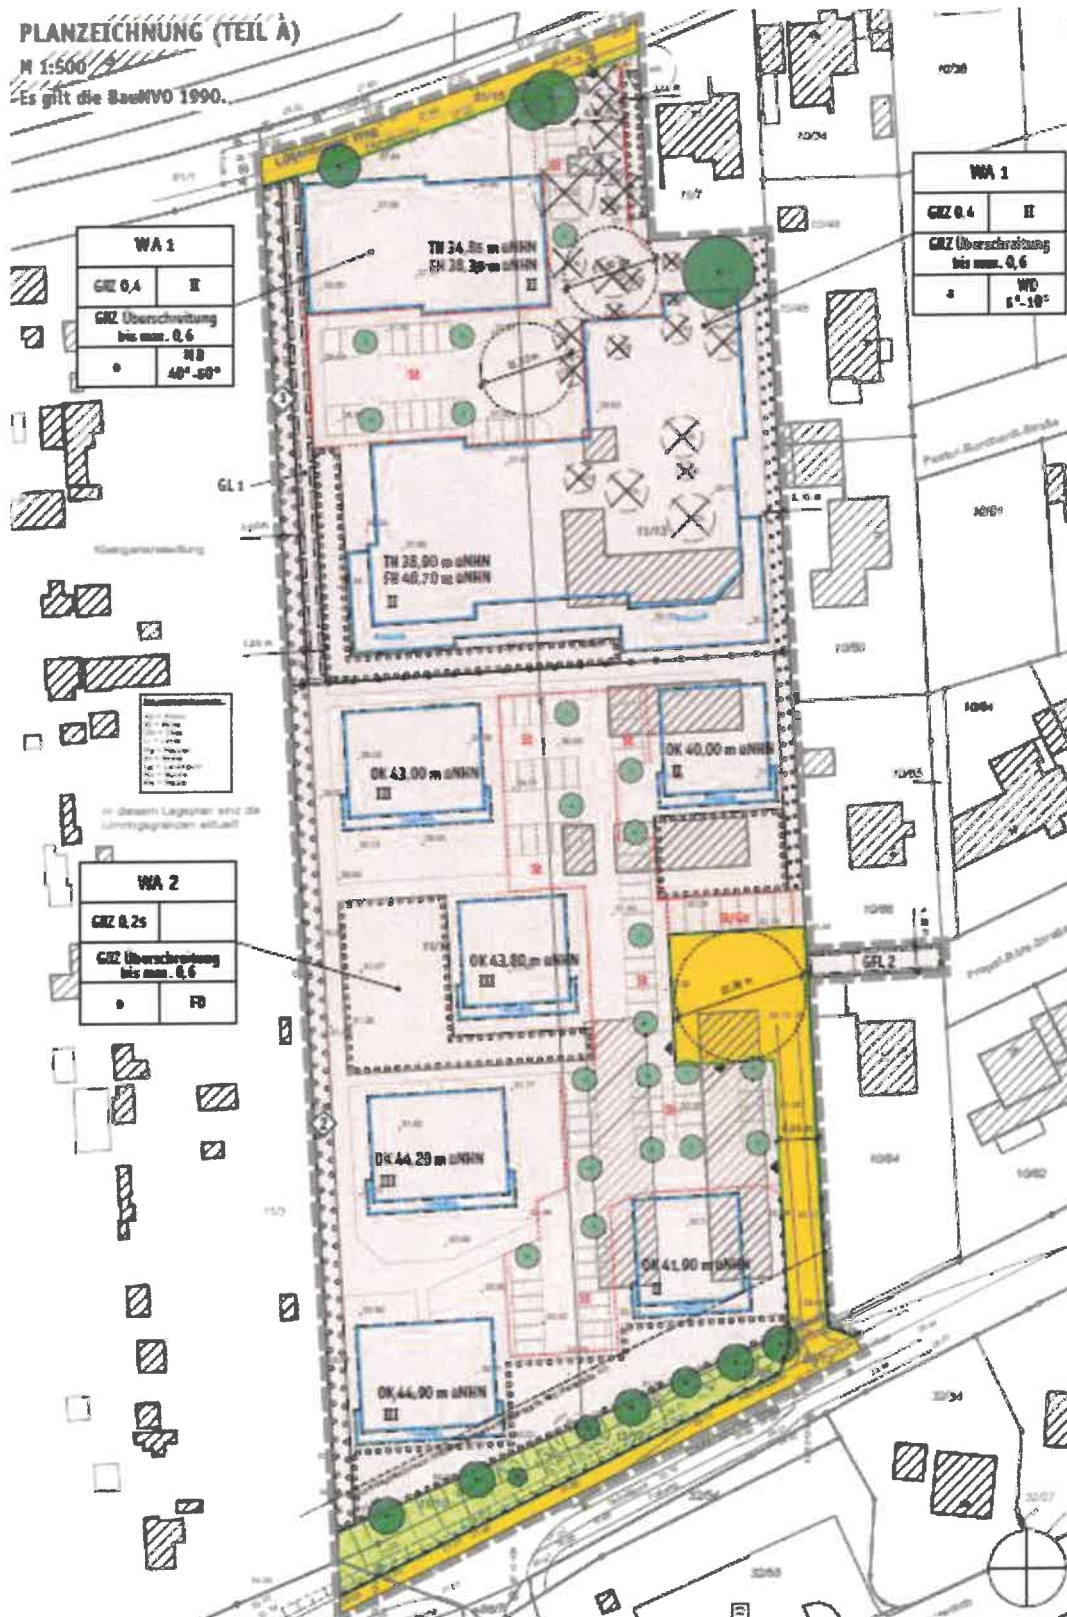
Planzeichnung zum B-Plan, Entwurf Stand Oktober 2017 (SWUP GmbH)
